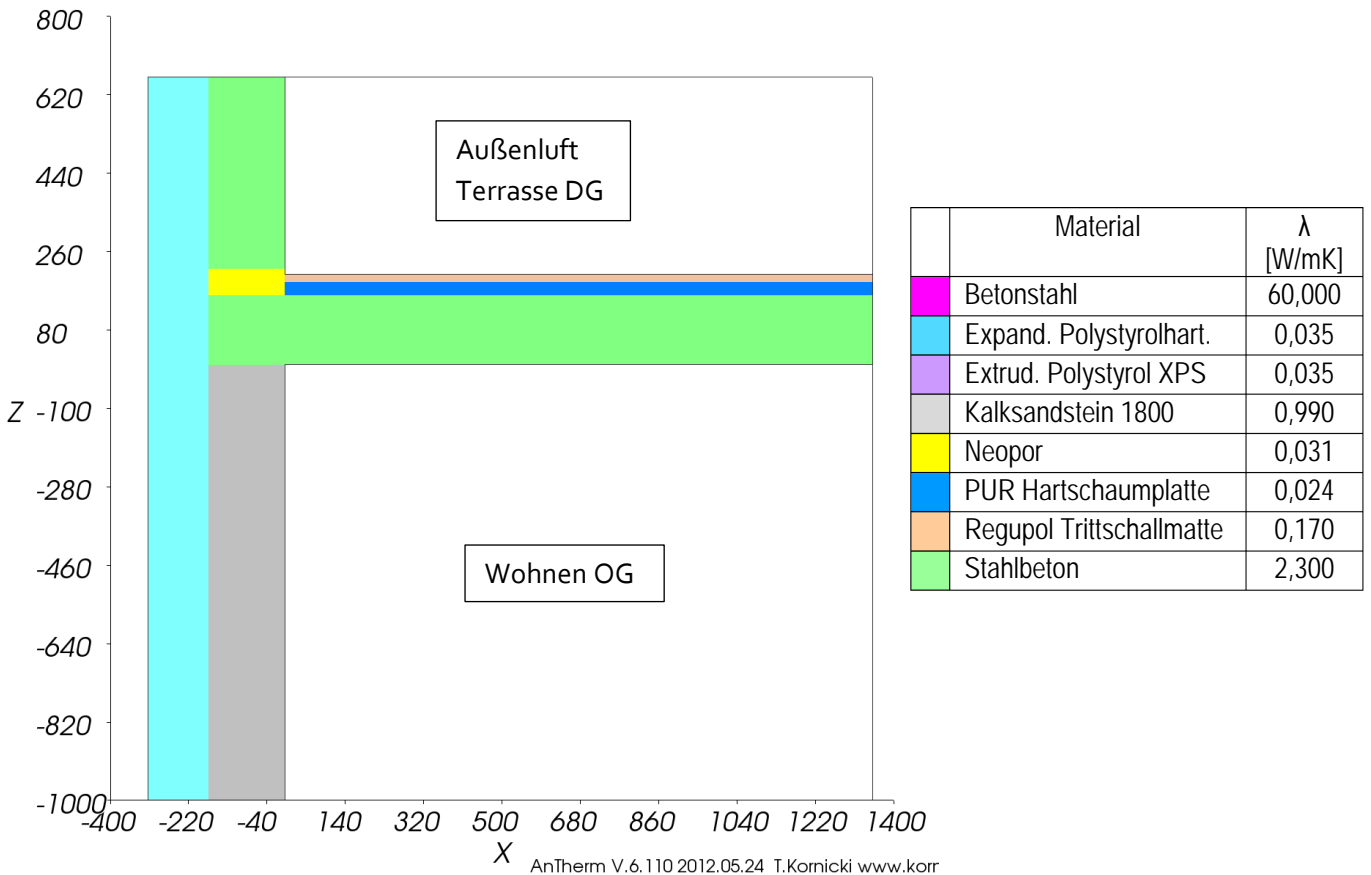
Vertikal-Schnitt (y=-661 mm)
